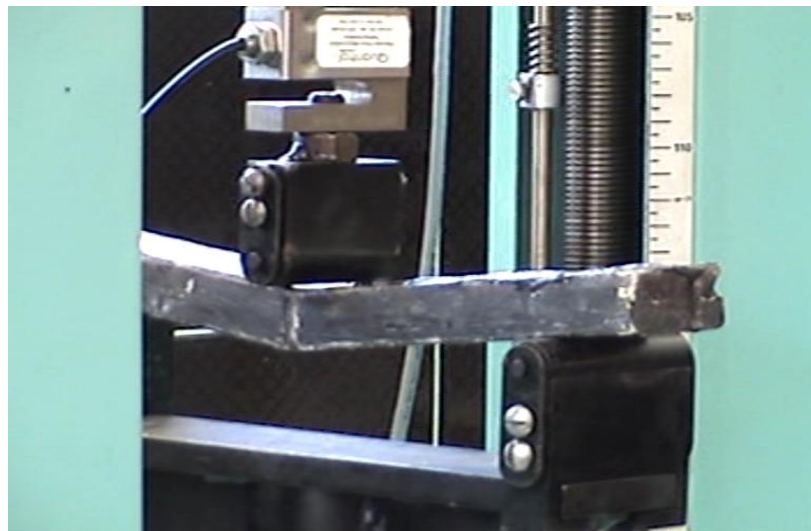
Falla de la viga durante el ensayo destructivo.
